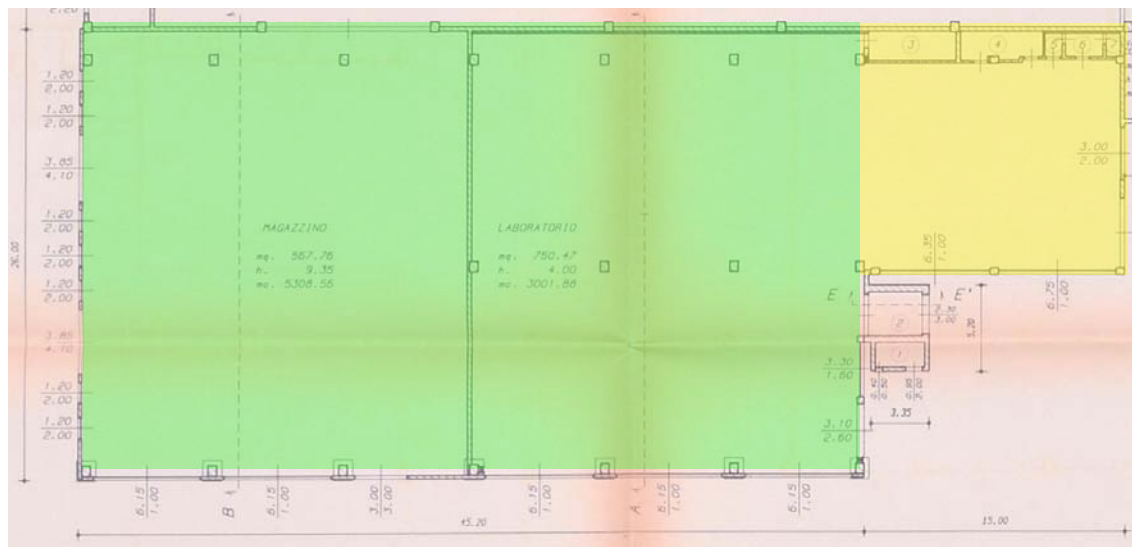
Particolare di A.1990.cap.us.T02 - Pianta piano terra - Porzione M e m dell'edificio
